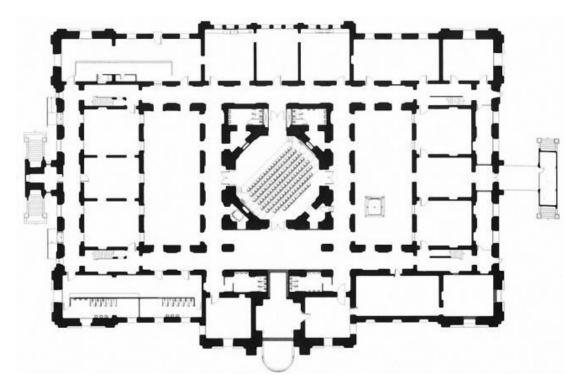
Plano de la planta baja de la Pinacoteca de Estado
